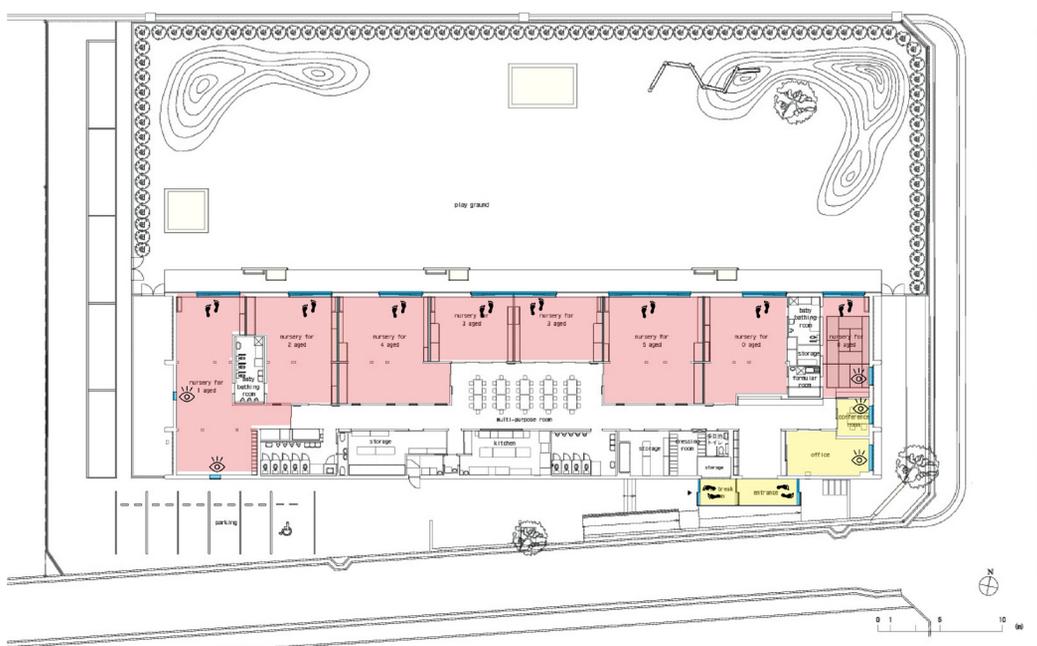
Planta arquitectónica escuela Leimond- Shonaka Nursery School
